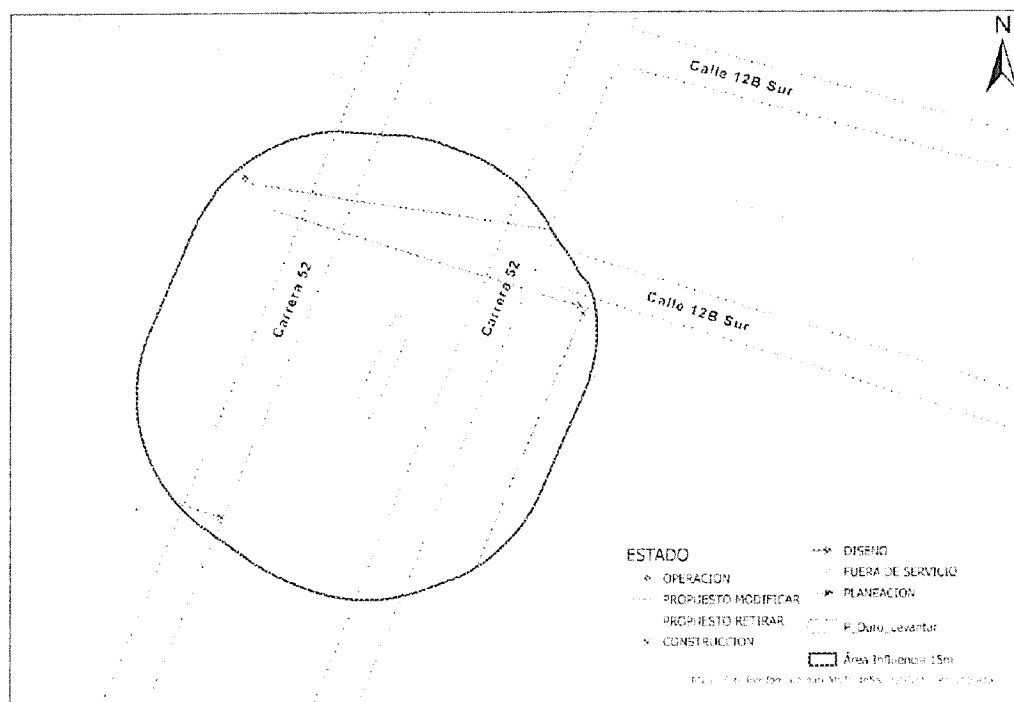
Distribución espacial por estado para la red de alcantarillado.
